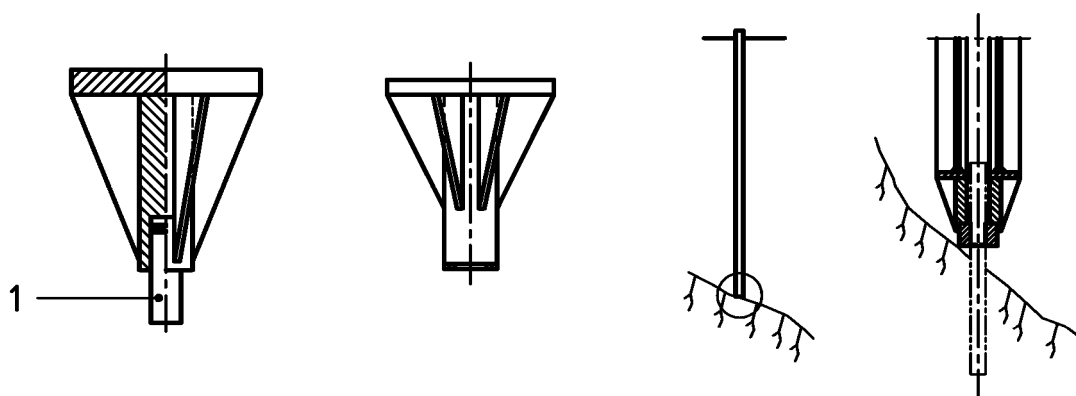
Ejemplos de secciones transversales de pilotes con desplazamiento de terreno
